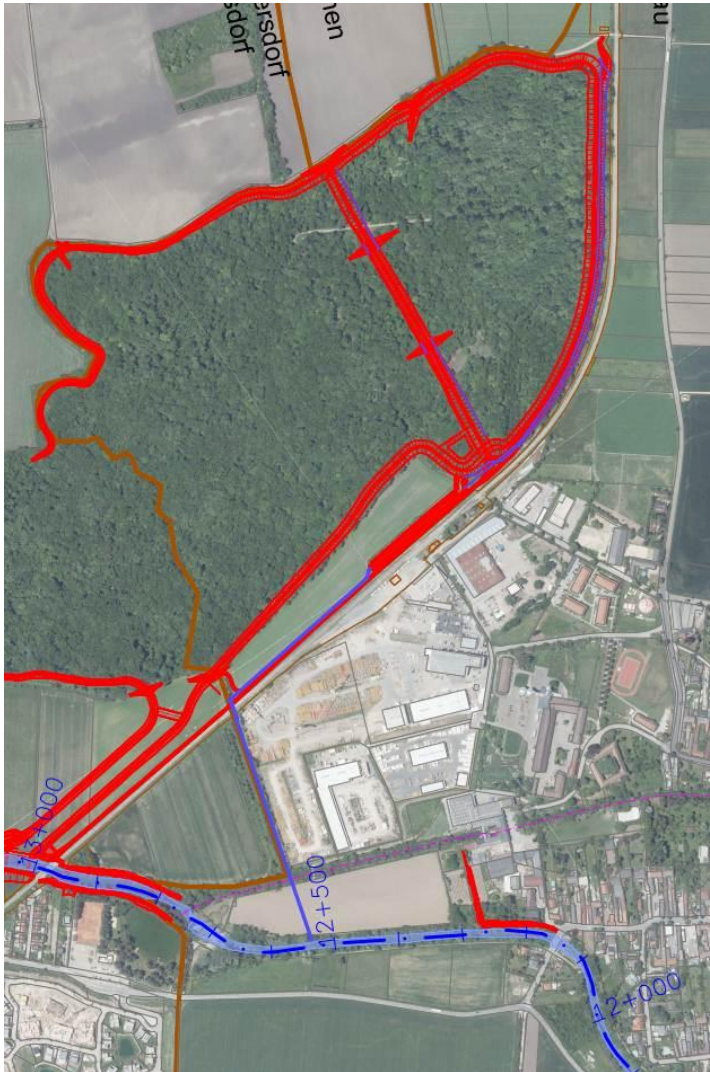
TR Trumau Auwald, Ausschnitt Gesamtübersichtsplan (Einlage 003)
